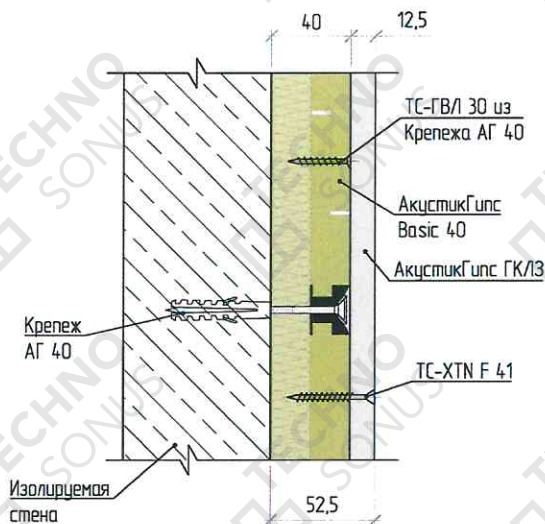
Конструкция бескаркасной системы звукоизоляции стены «Слим А1»
